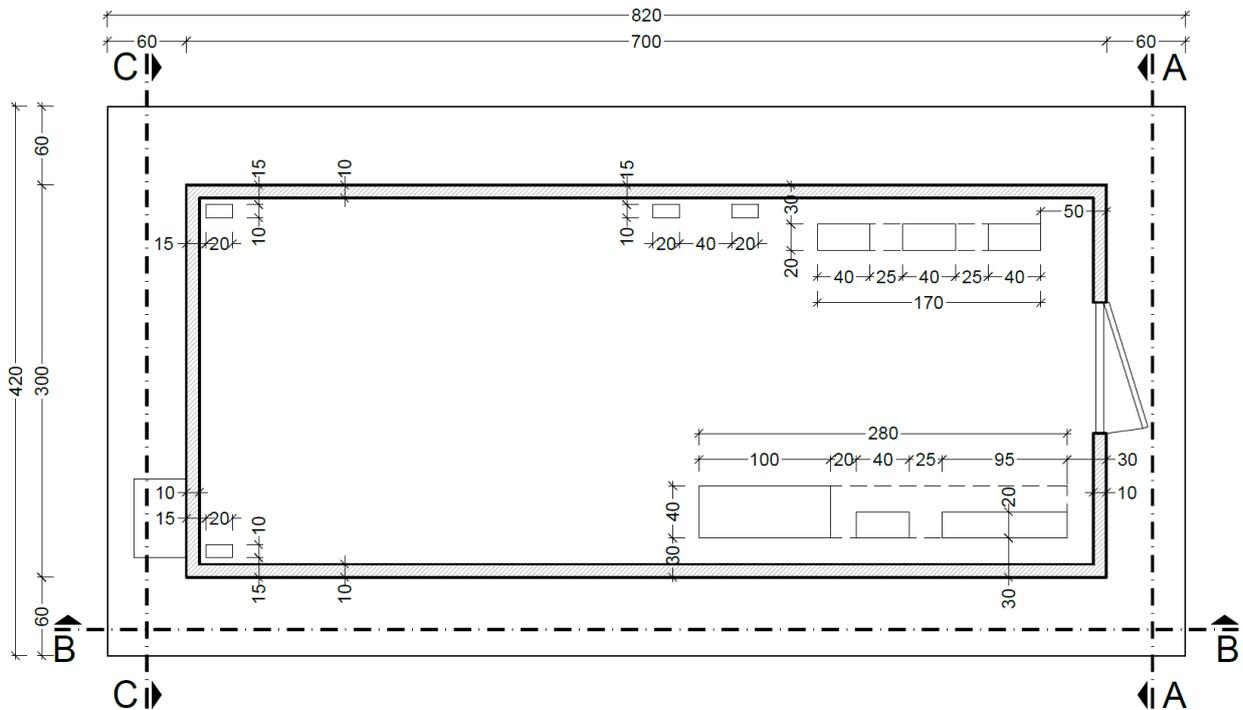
Pianta tipo basamento fondazione PPT con indicazione forometrie
